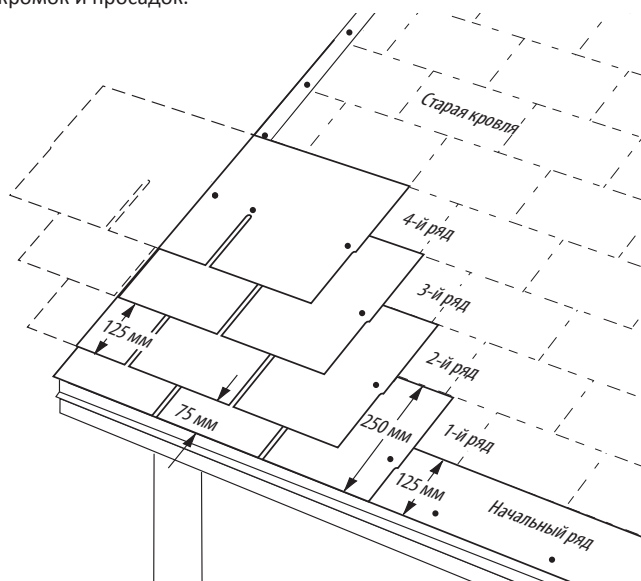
Укладка гонта на существующую кровлю встык со старым гонтом.
